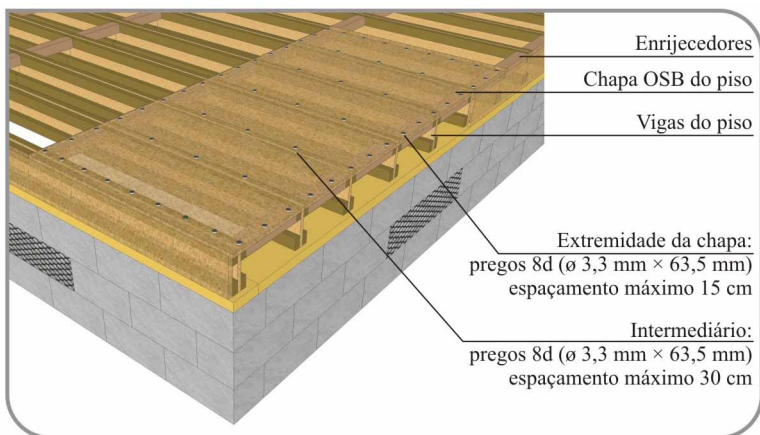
Chapas OSB pregadas sobre vigas do piso e elementos enrijecedores
